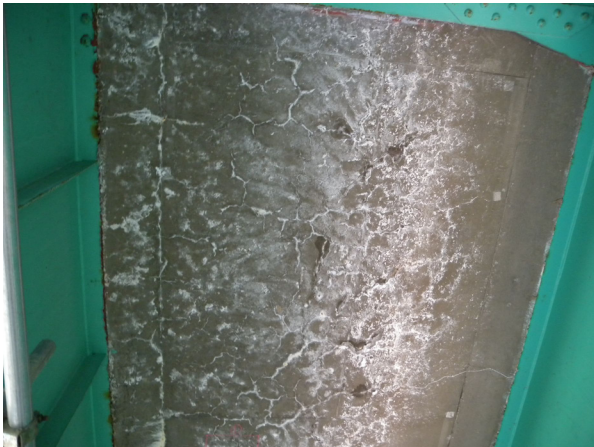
2方向ひび割れと押抜きせん断破壊
